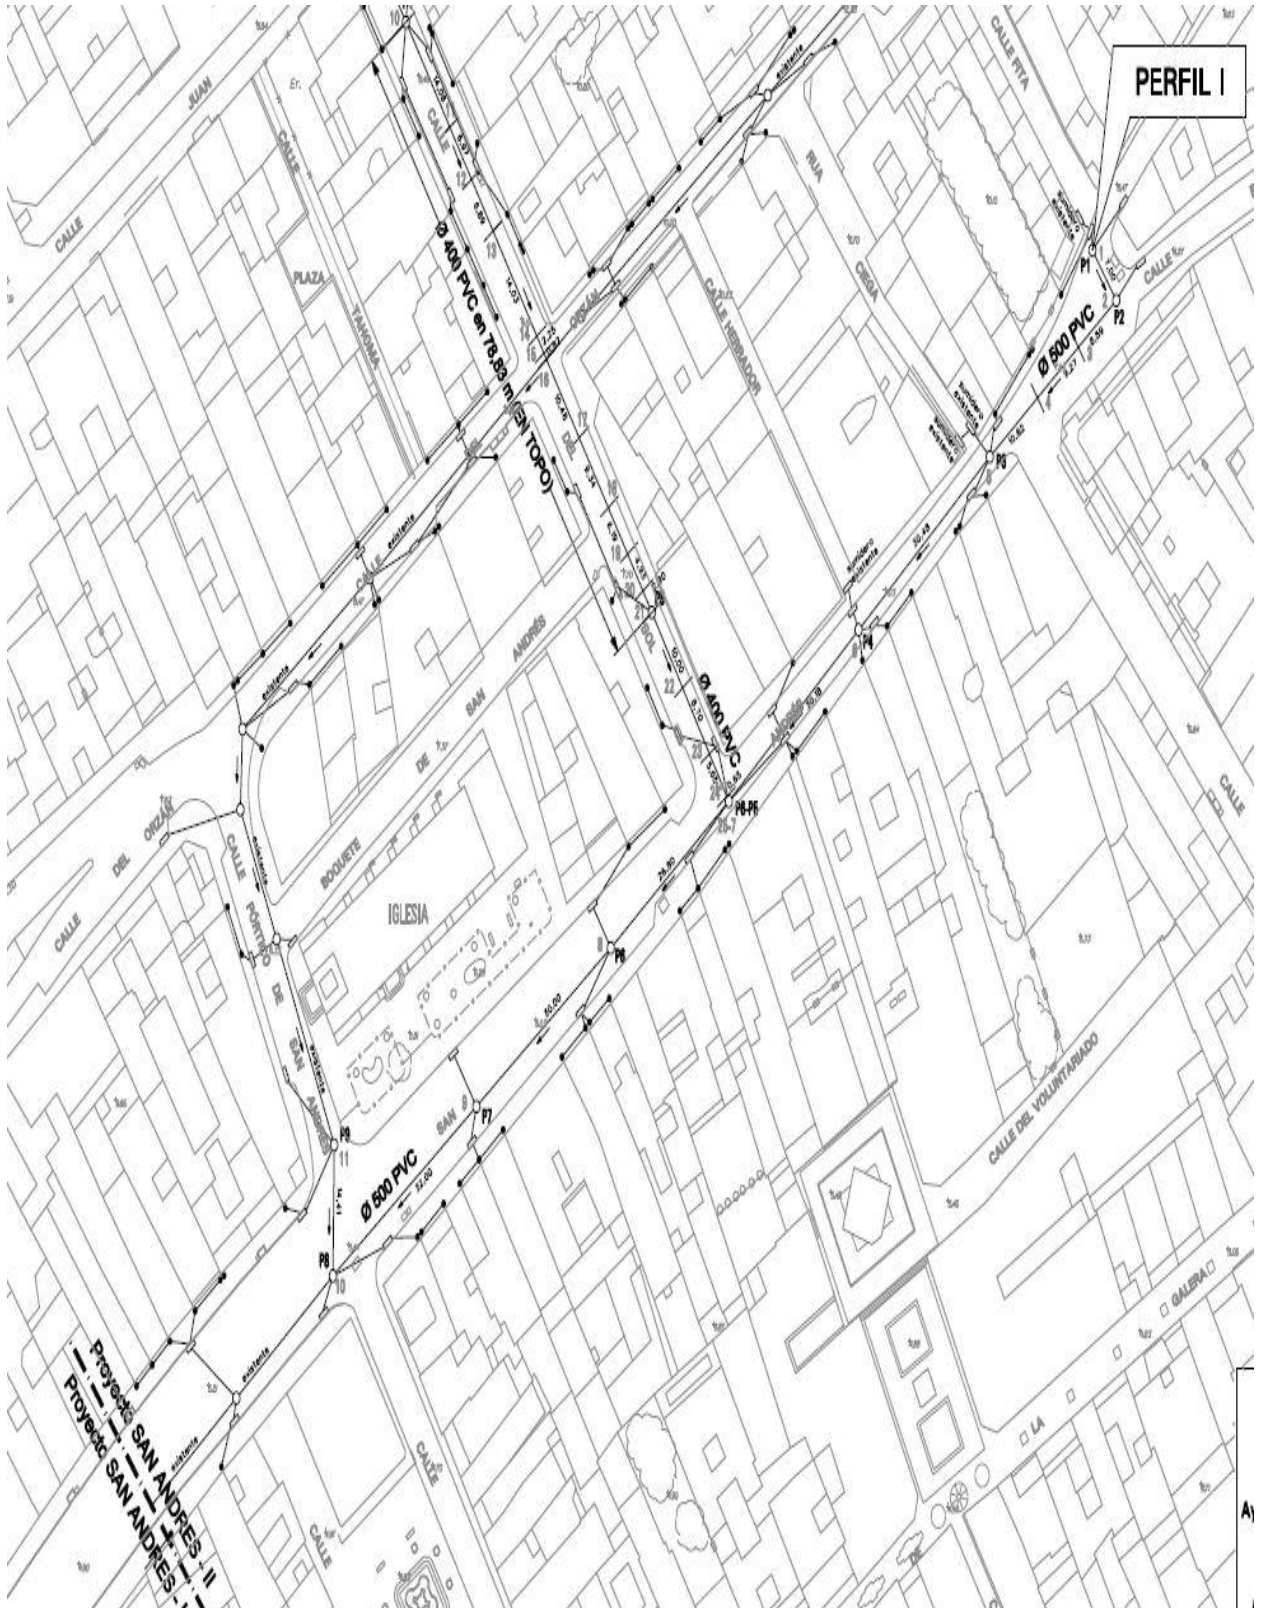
Plano de distribución de Pluviales y Alcantarillado.
